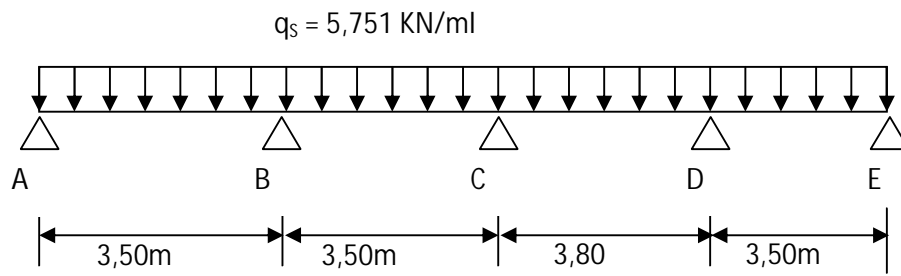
Schéma statique de la poutrelle.
